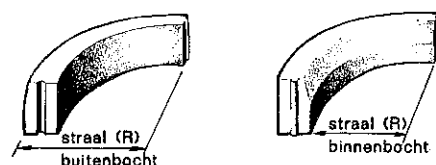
b. Zichtkantmeting van trottoirbanden ('Boot' beton).
